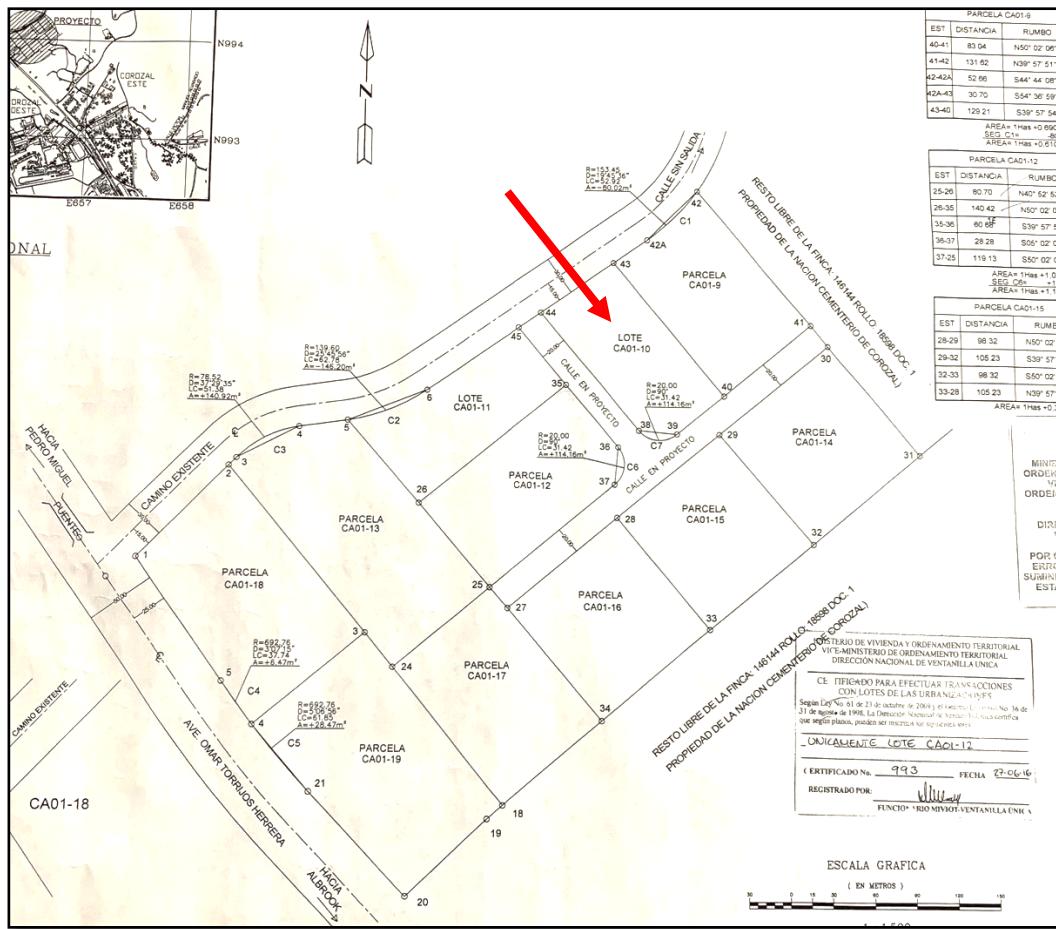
Linderos del Proyecto, Fuente: Plano con código 8071407-054
